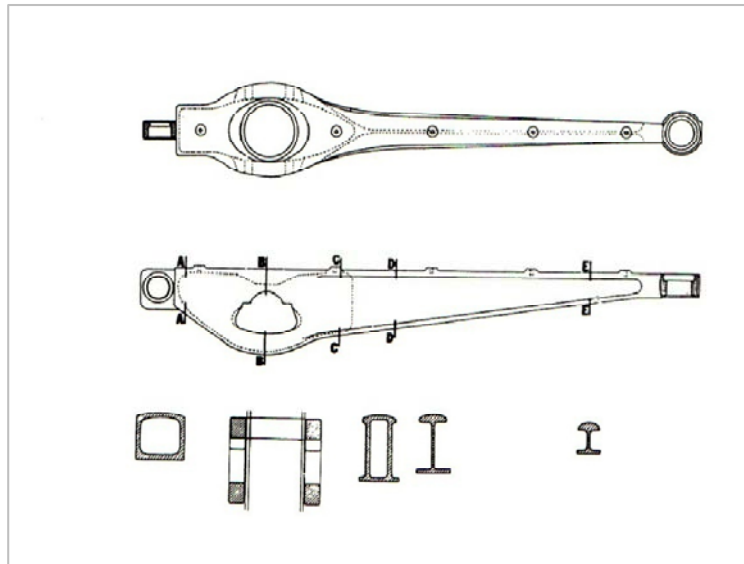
« Plan, coupe longitudinale et coupe transversale de la gerberette, montrant les différentes sections. » (Rice, 1990)
